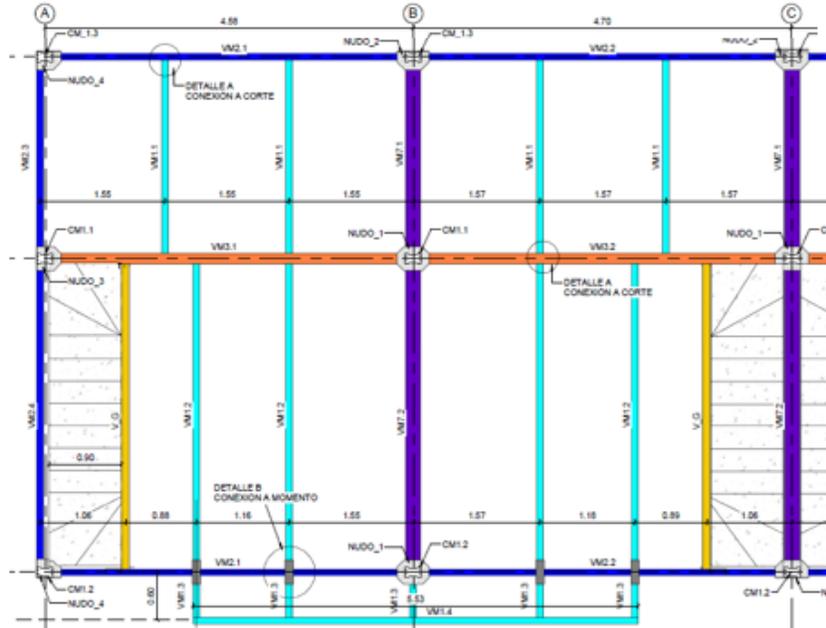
Planta estructural, primera planta. Urbanización "Los Capulies".
